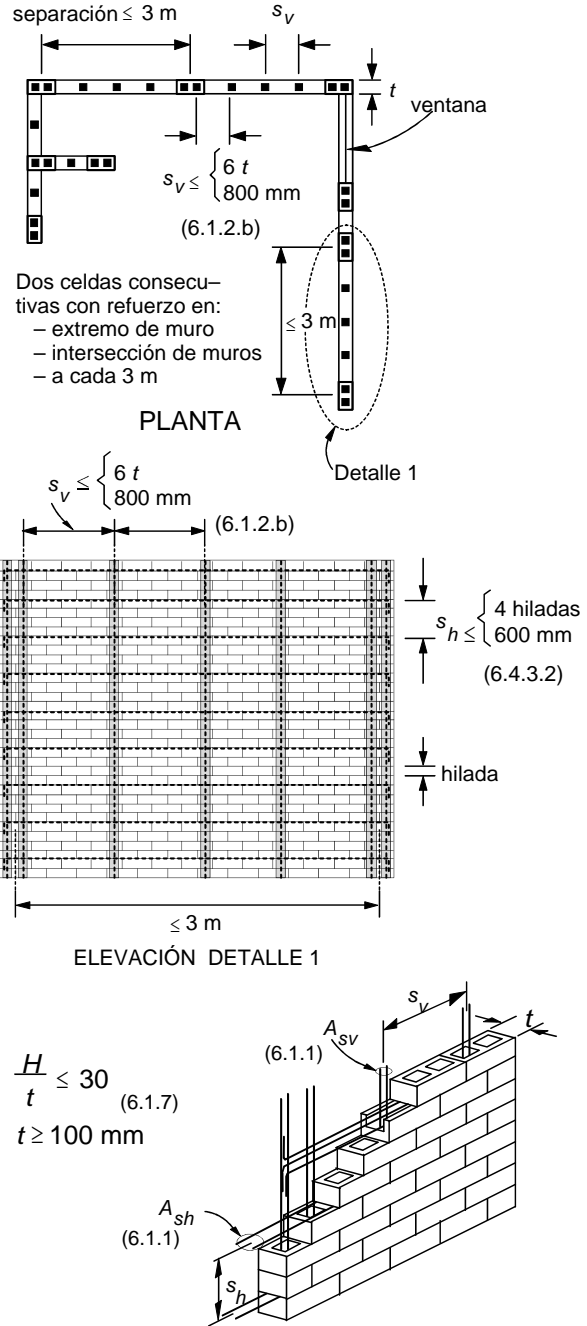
Requisitos para mampostería con refuerzo interior
